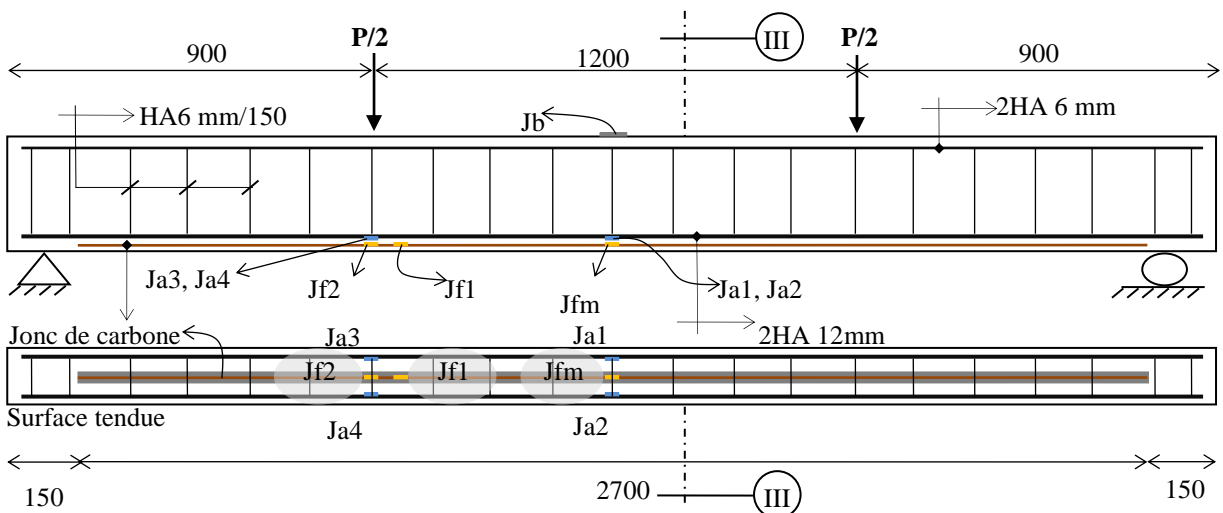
Instrumentation et dispositif de chargement en flexion 4 points des poutres P.
